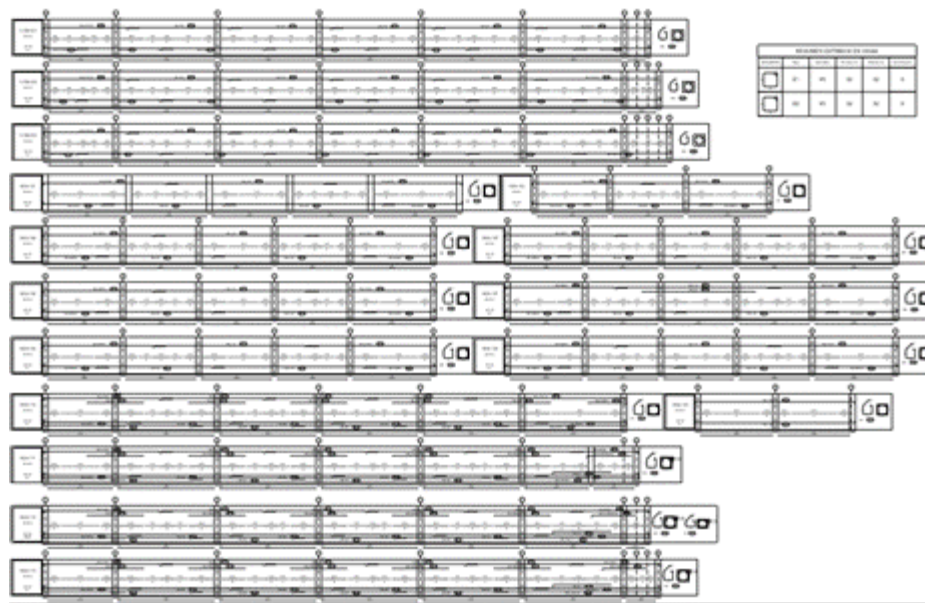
DESPIECE DE COLUMNAS. FUENTE: CONSTRUCTORA
